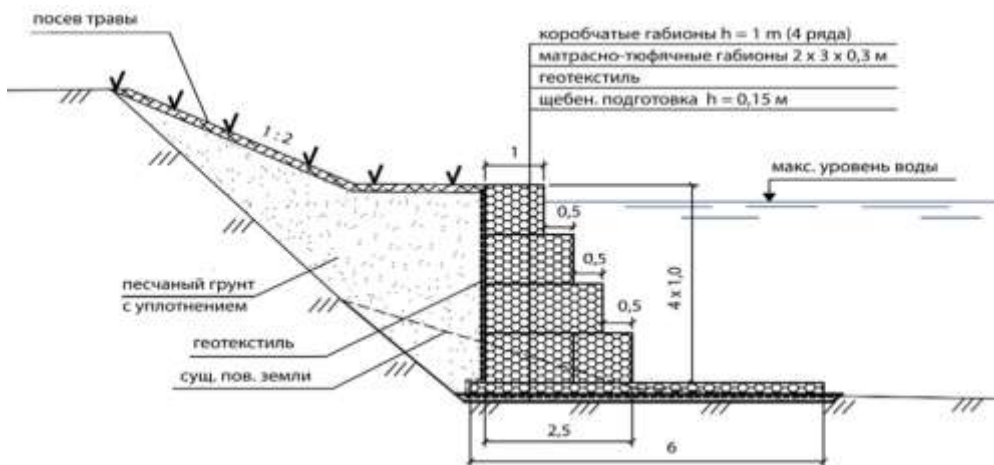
Схема крепления подтопленного откоса габийонной конструкцией.
